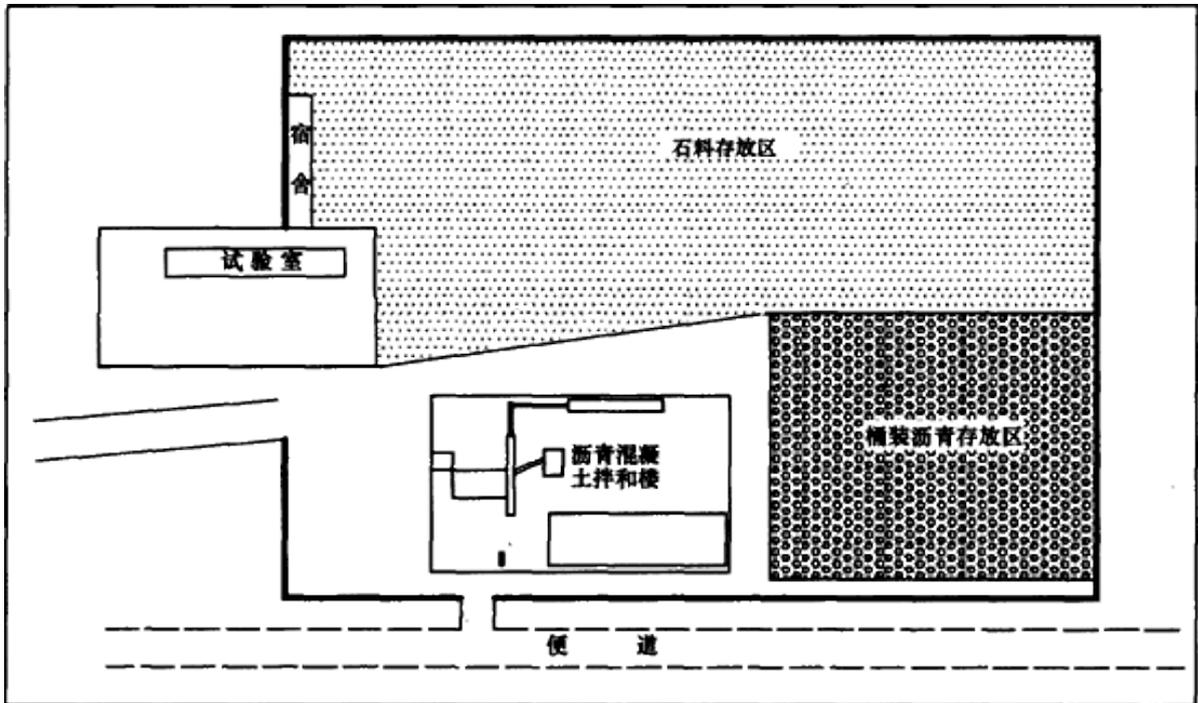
B420163-2 某沥青混凝土拌和站平面布置示意图
